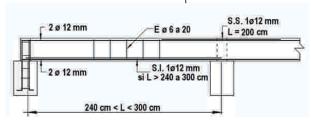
41: Plano detalle de la armadura de la viga de fundación.
